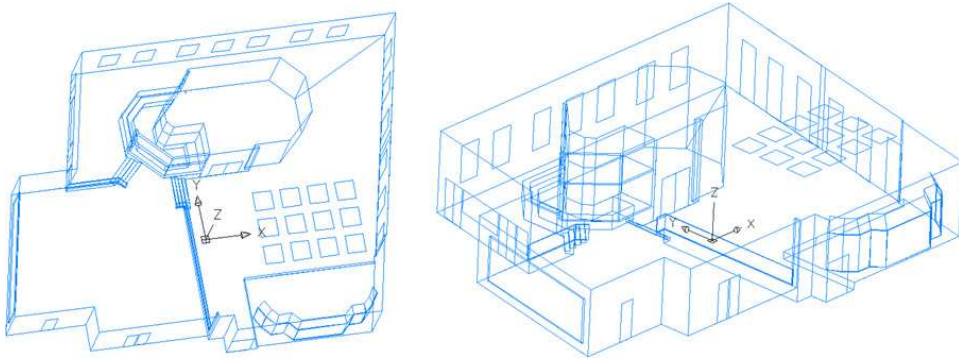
3dPolylines* traçadas a partir da planta baixa, elevação e cortes originais em *AutoCAD*, vistas em duas perspectivas.
